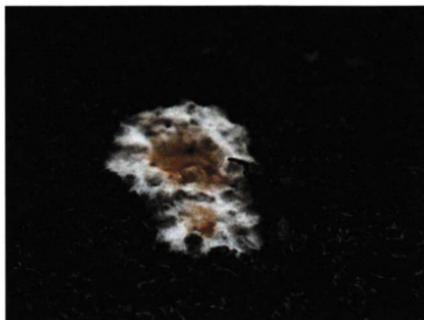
Detail des kleinen Fruchtkörpers des Braunen Kellerschwammes; an der Oberfläche steht das Wasser, da die Dachableitung nicht funktioniert.
